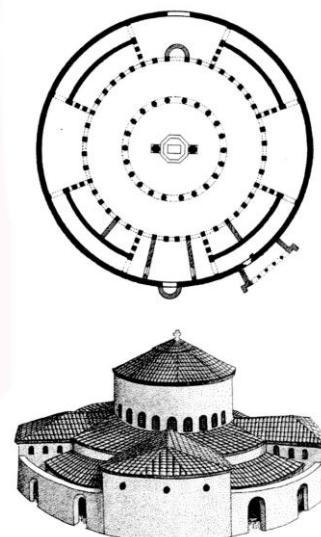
Santo Stefano Rotondo, Roma, século XII (Planta e reconstrução geral)
